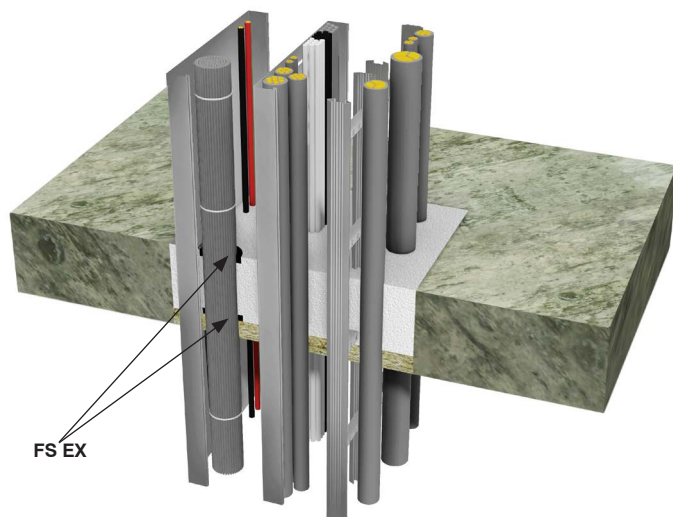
Betongplatta 150 mm. Tjocklek GPG 200 mm
